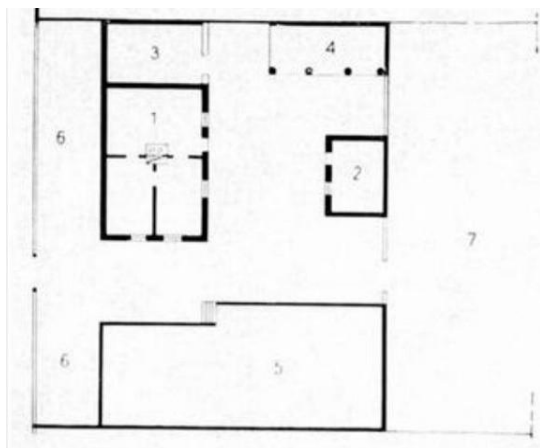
Схема генерального плана армянской усадьбы середина XIX в.
